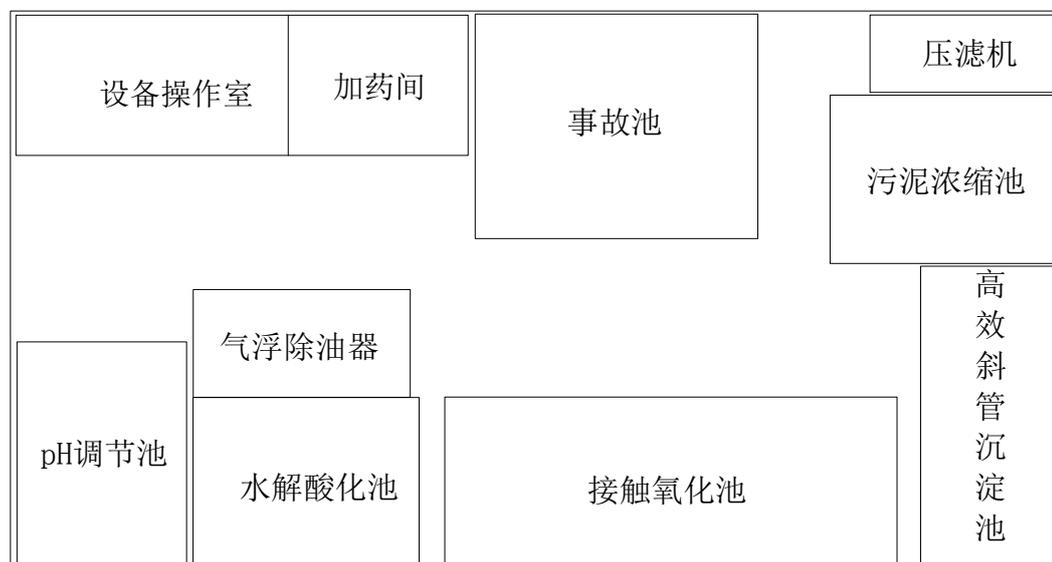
柳焊车间前处理线废水处理站总平面布置图
